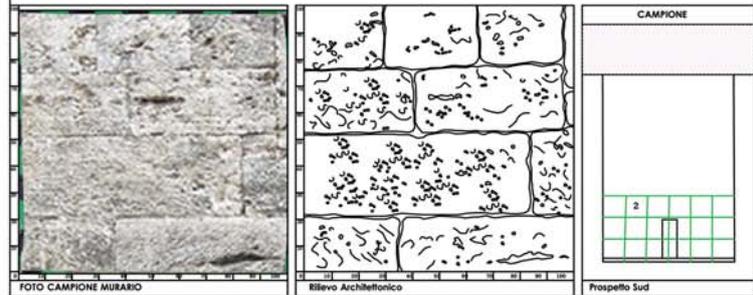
FOTO CAMPIONE MURARIO Rilievo Architettonico Prospetto Sud
